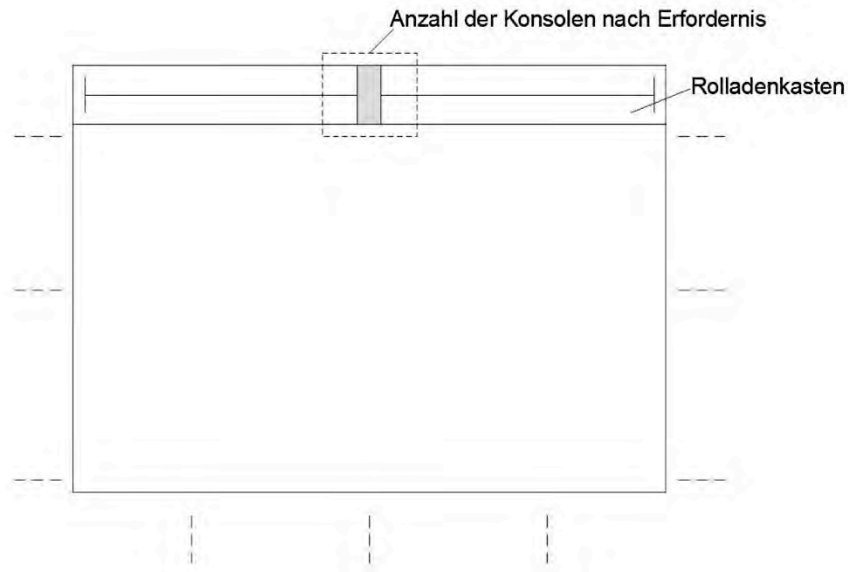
Darstellung einer weitgespannten Rolladenanlage mit Einsatz einer tragenden Konsole
